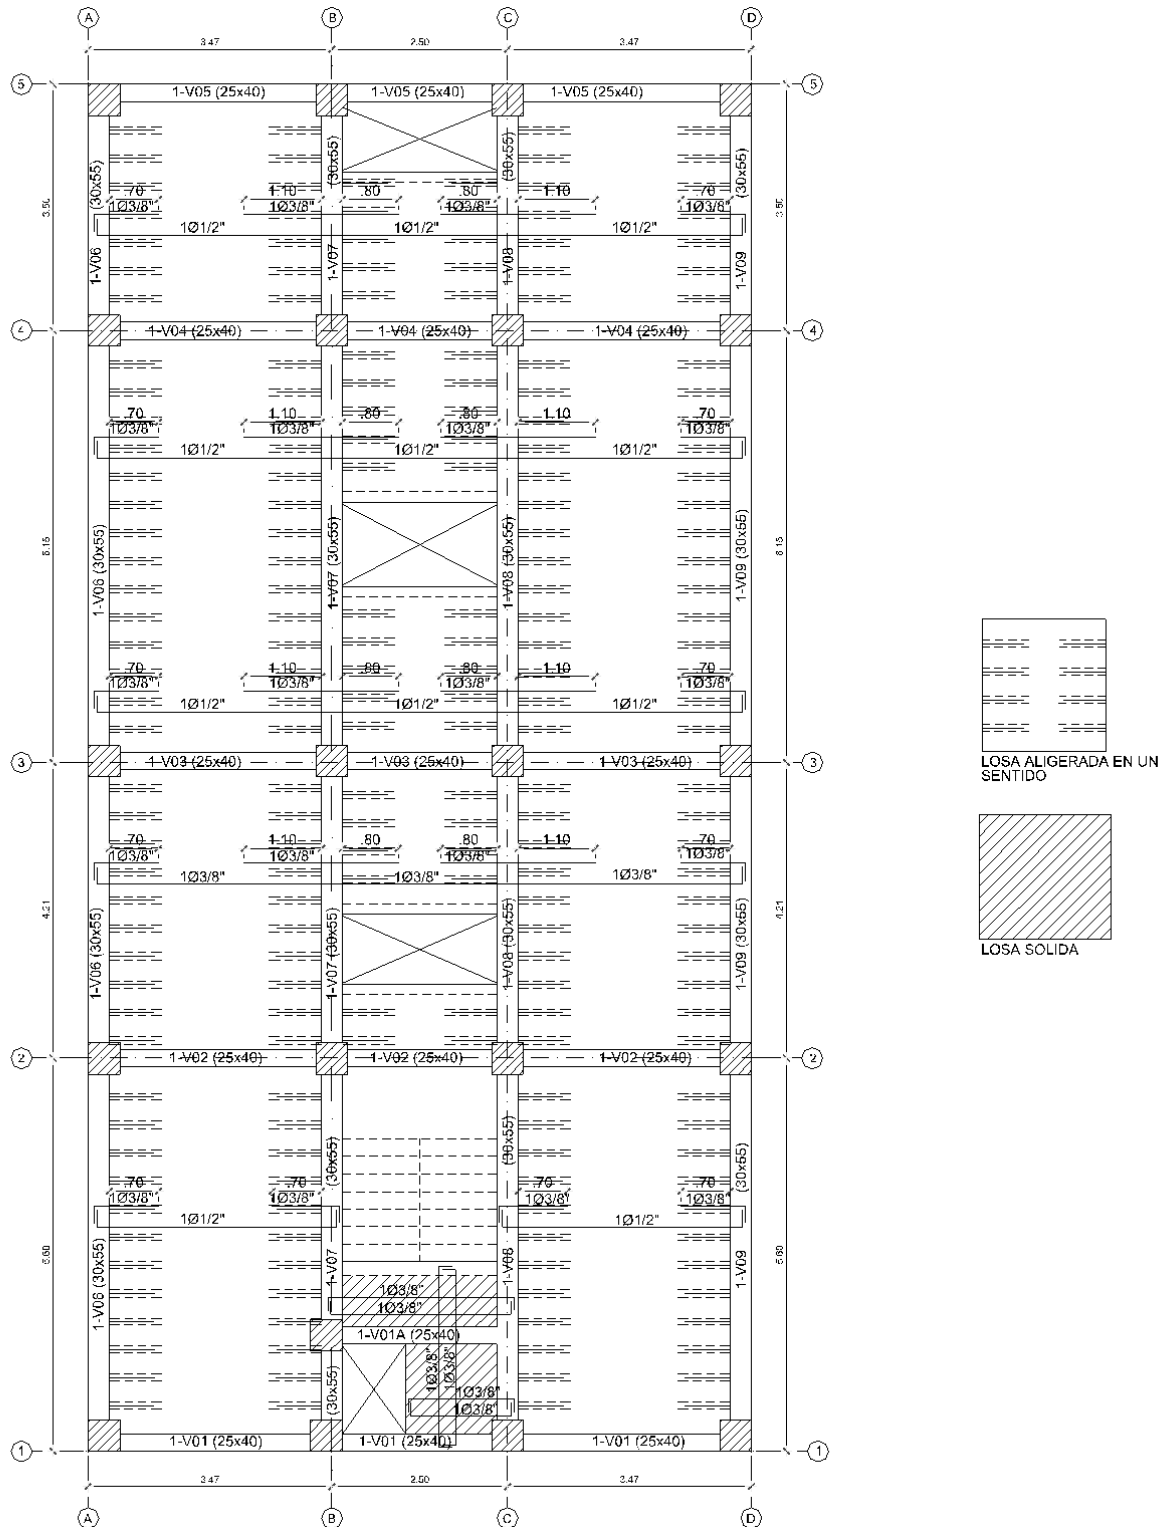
Planta de encofrado (típico para todos los pisos), las sobrecargas usadas en sus encofrados son de 200 kgf./m² (Cuartos, baños, escaleras)
